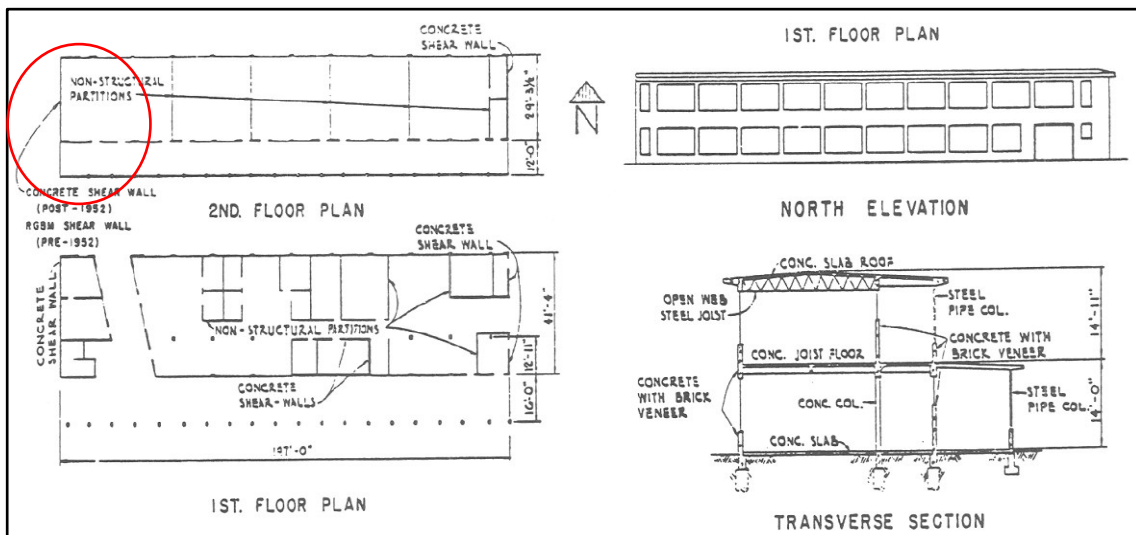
Vista en planta y en elevación del edificio administrativo de Arvin High School
